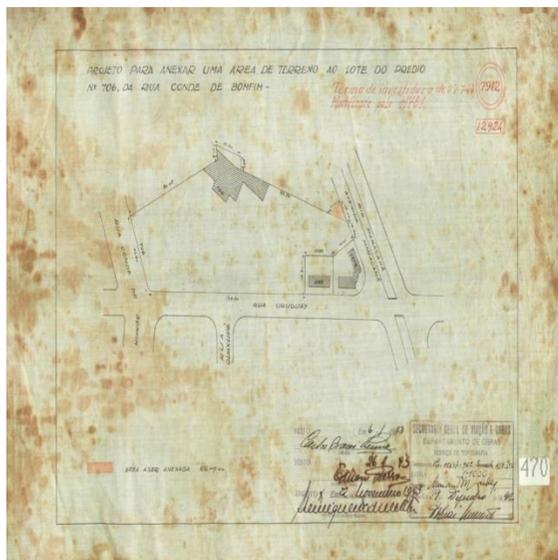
Outras dinâmicas ocorrem e terrenos aumentam de tamanho
